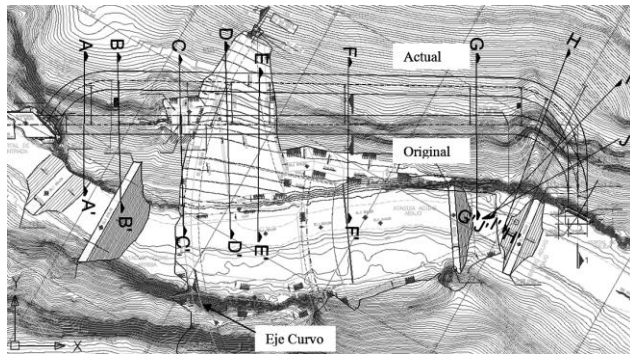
Planta con el trazo original y actual del túnel de desvío.
